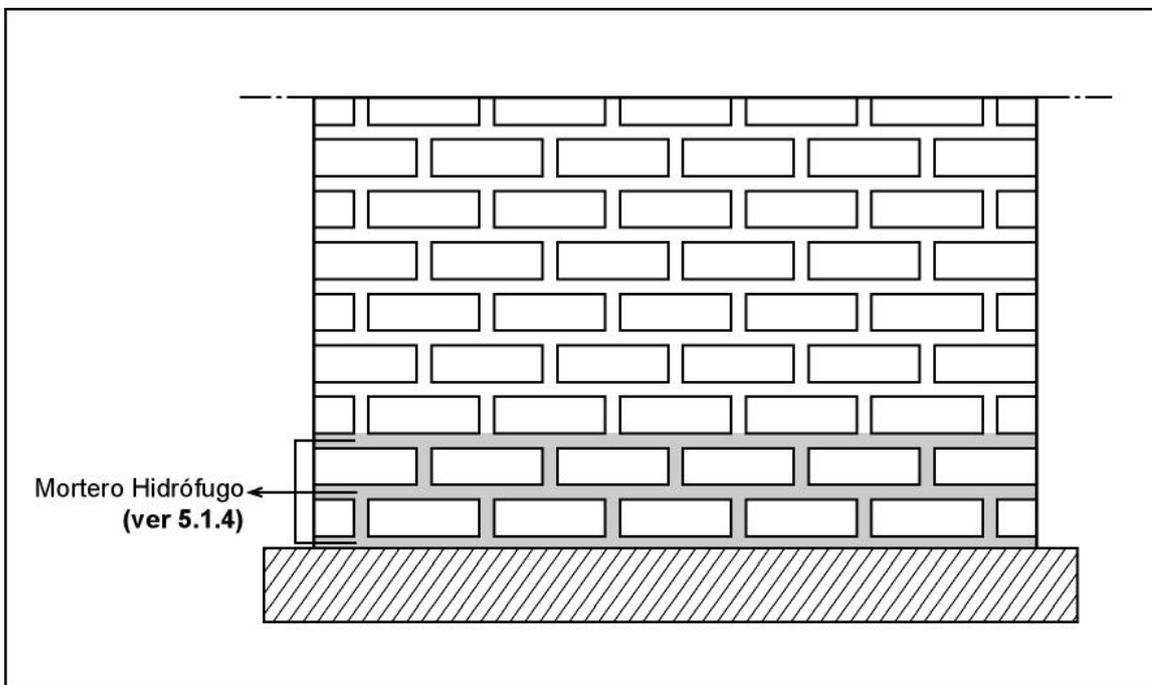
Reemplazo de mortero común por uno hidrófugo en un muro de albañilería
